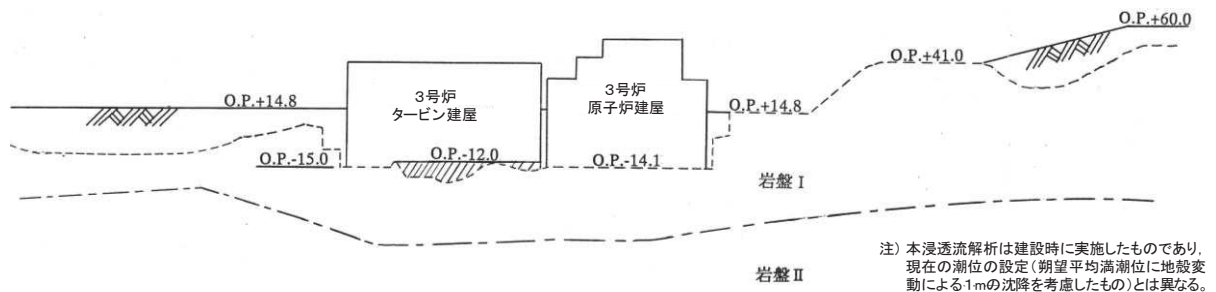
浸透流解析断面図 (E-E' 断面)
